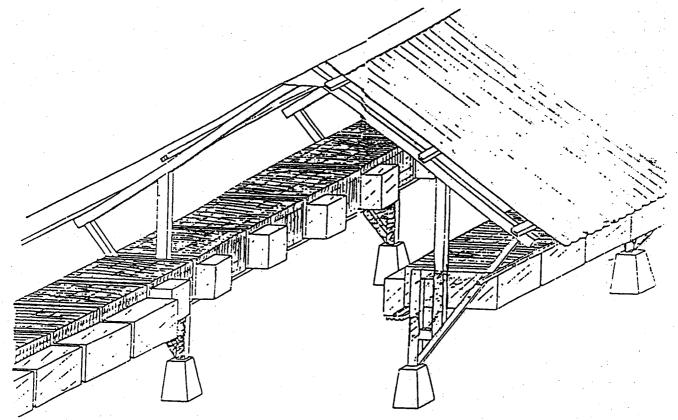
Modelo de estructura al aire libre moderna con techo de doble vertiente y pasillo central, con soportes y armazón de madera.
